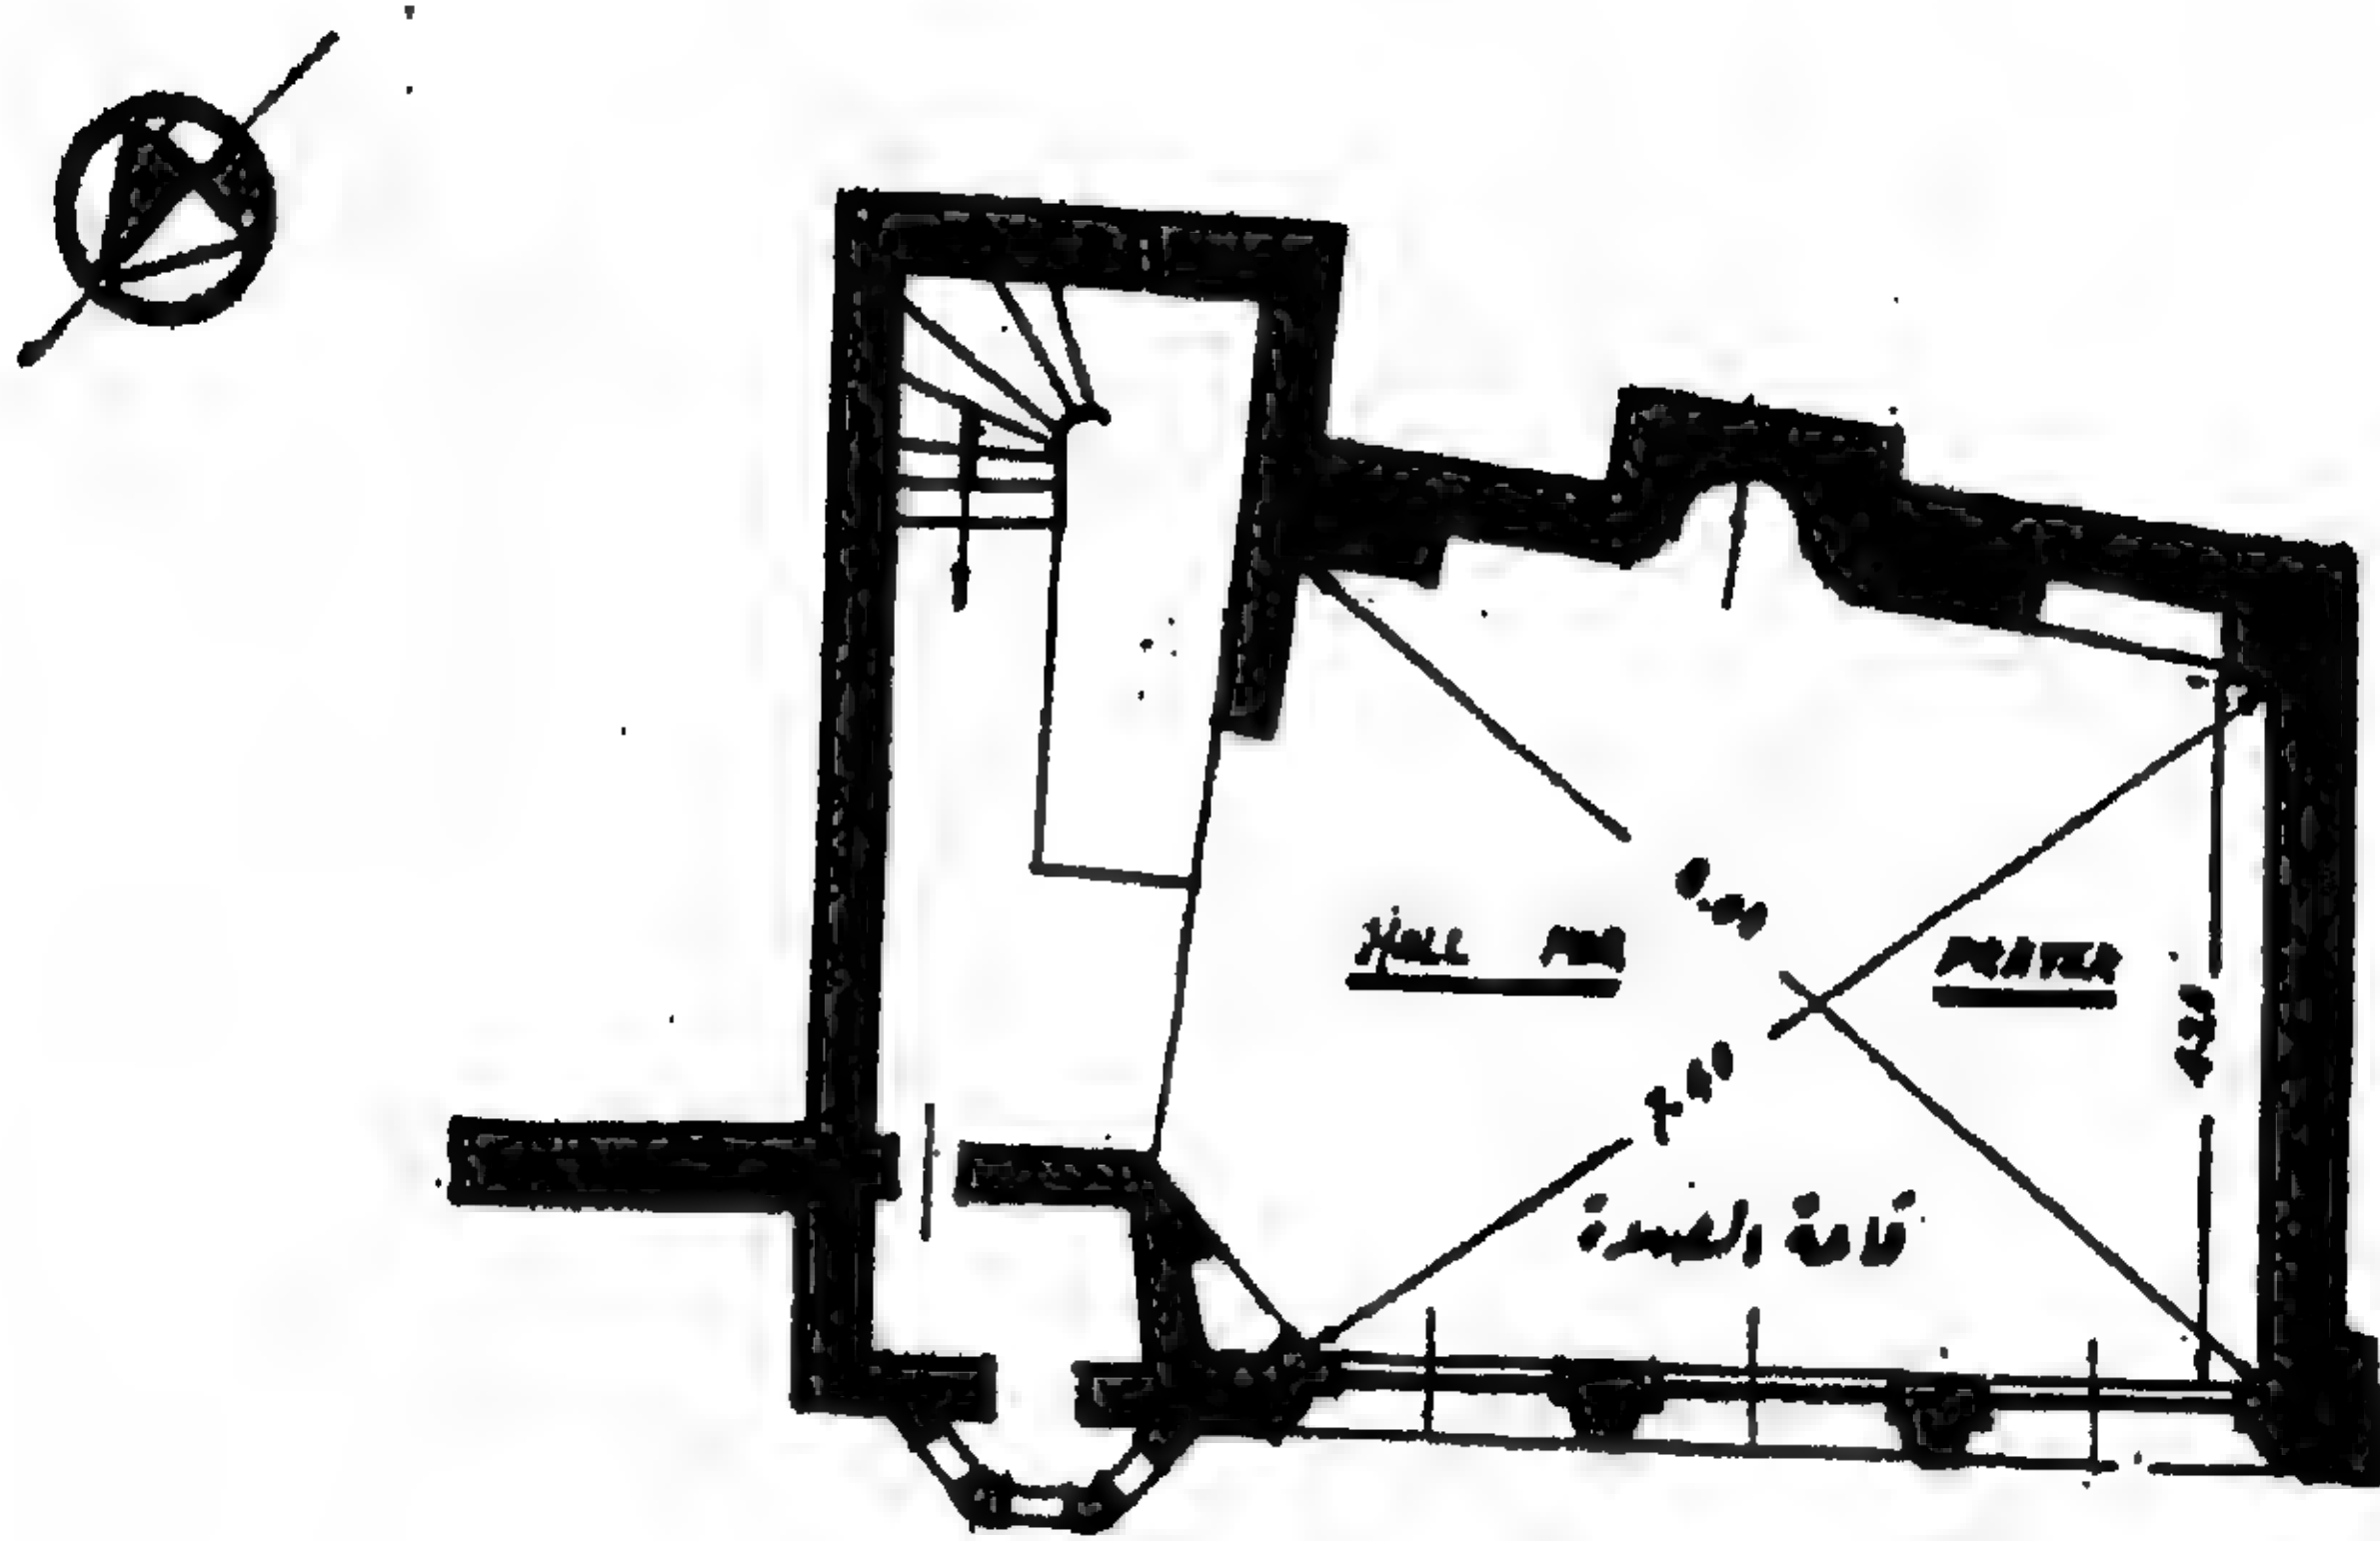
مسقط أفقى لجامع الغريب خلف مستشفى الحسين الجامعى.
